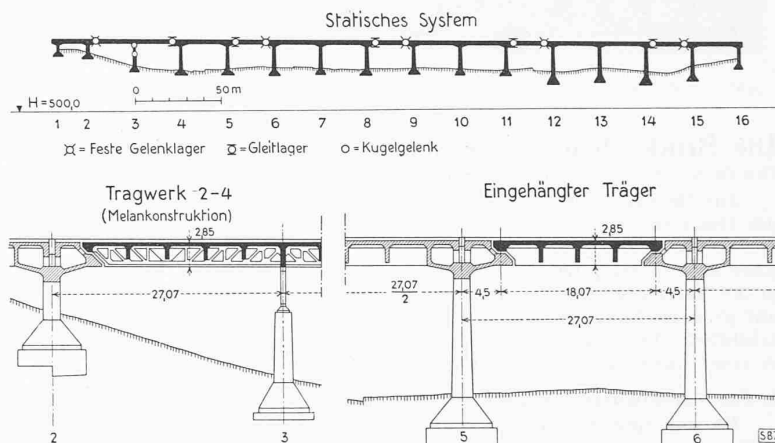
Statisches System des Abschnittes 2 (Los 2), 1: 4000; Eisenbeton-Tragwerk 1: 800
